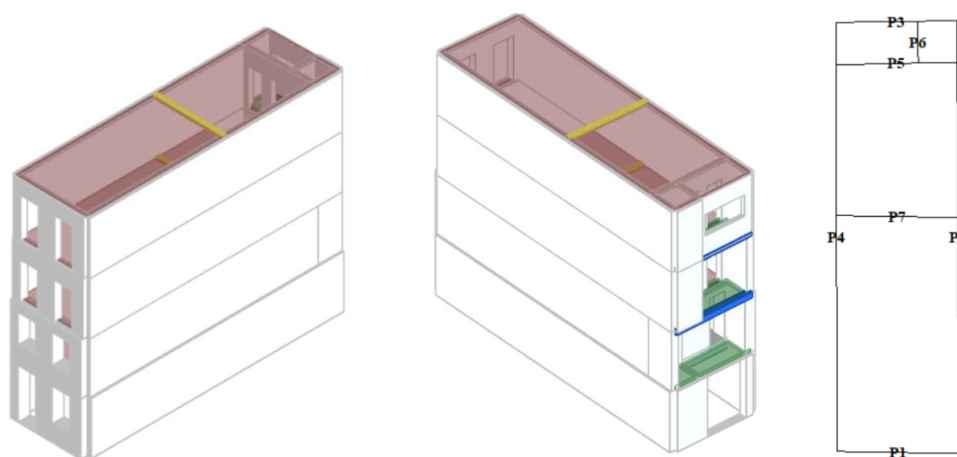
Modelo Rua do Almada e planta respetiva
